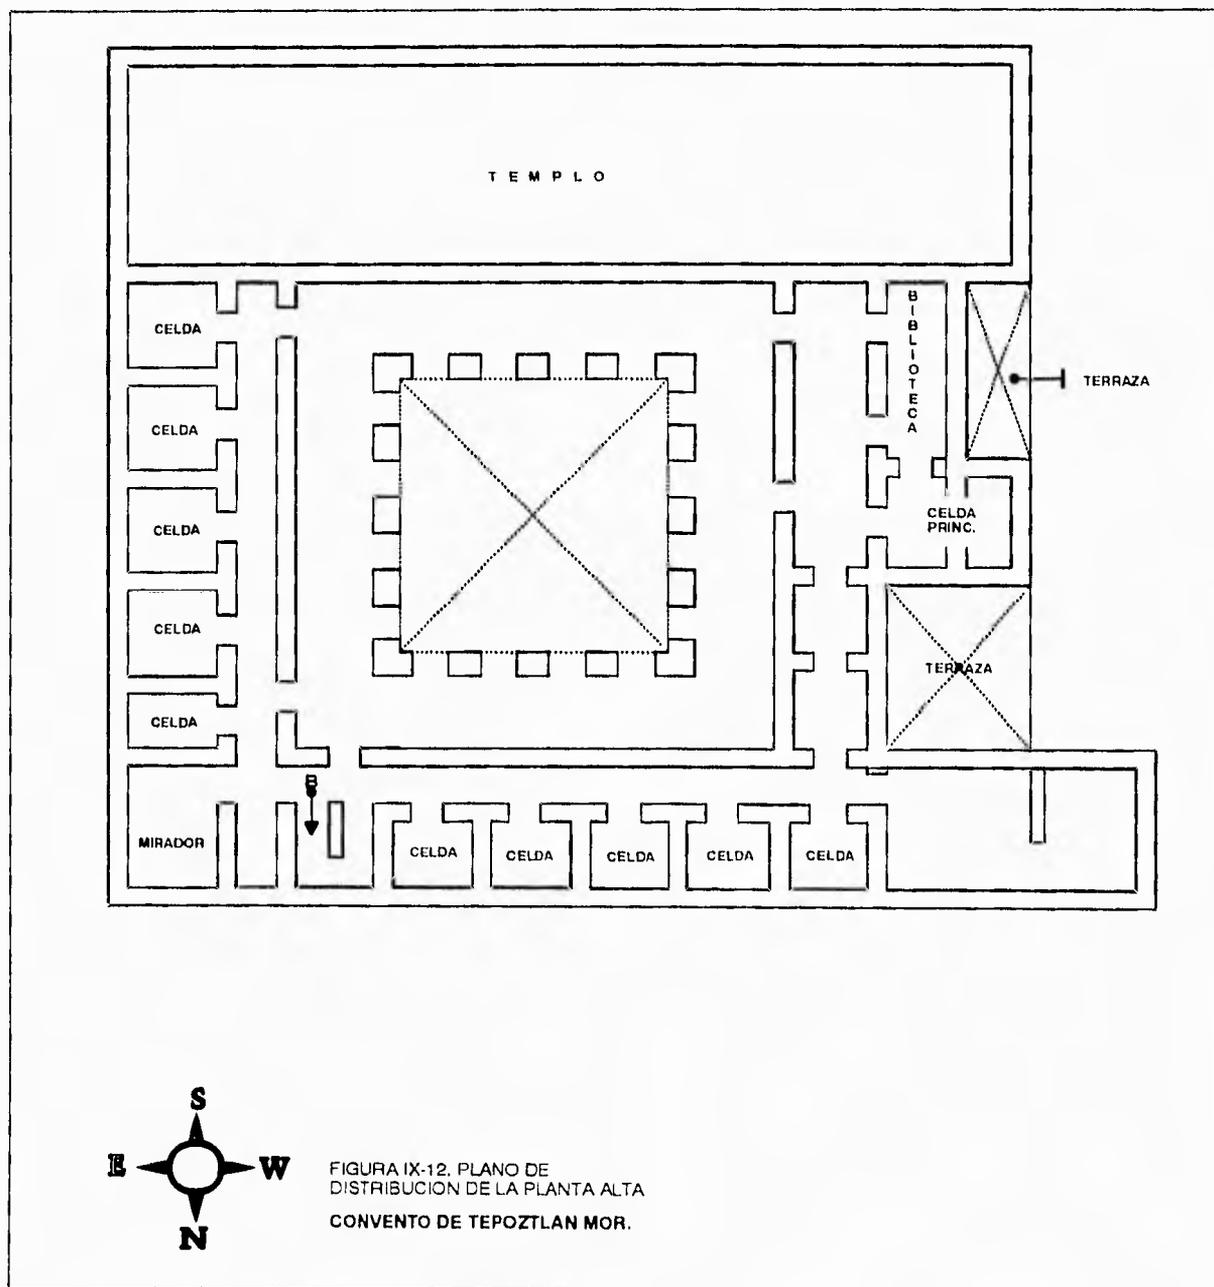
Plano de distribución de la planta alta del convento de Tepoztlán.
